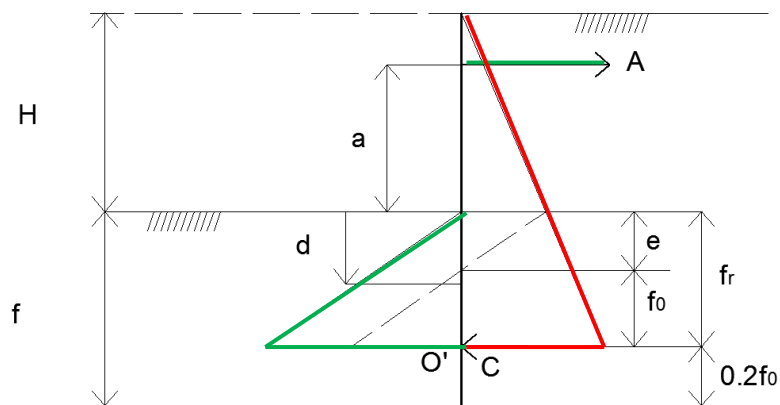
Soutènement avec ancrage encastré en pied (d'après Blum, 1931). H : hauteur soutenue, f : fiche, e : point de pression nulle, f_0 : fiche minimale sous le point de pression différentielle nulle nécessaire à l'équilibre des moments en pied de l'écran, f_r : fiche réduite, C : contre butée, A : force d'ancrage.
